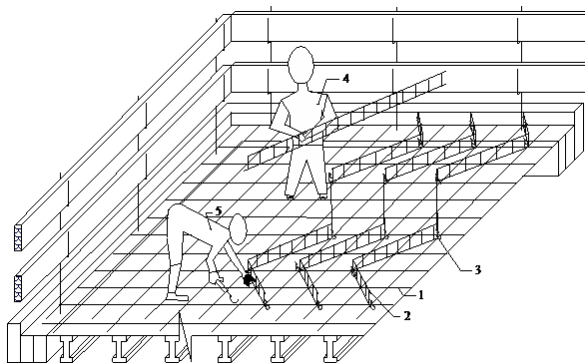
Установка поддерживающих каркасов: 1 стержни арматурной сетки; 2 поддерживающий каркас; 3 закрепление поддерживающего каркаса к арматурной сетке вязальной проволокой; 4 рабочий устанавливающий каркас; 5 - рабочий закрепляющий каркас
